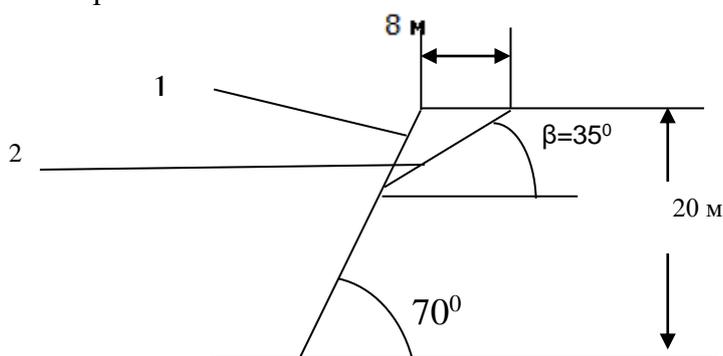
Схема поперечного сечения уступа: 1- откос; 2 - поверхность ослабления
